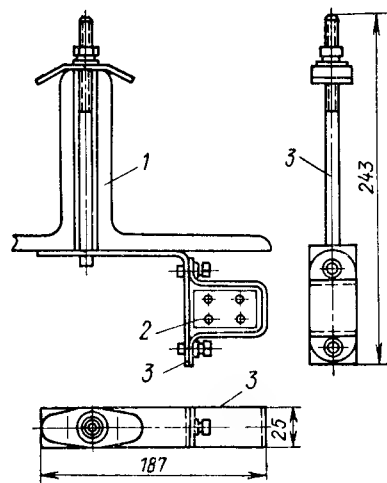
Подвеска K475 для крепления шинпровода ШОС-67 к нижнему поясу фермы.
